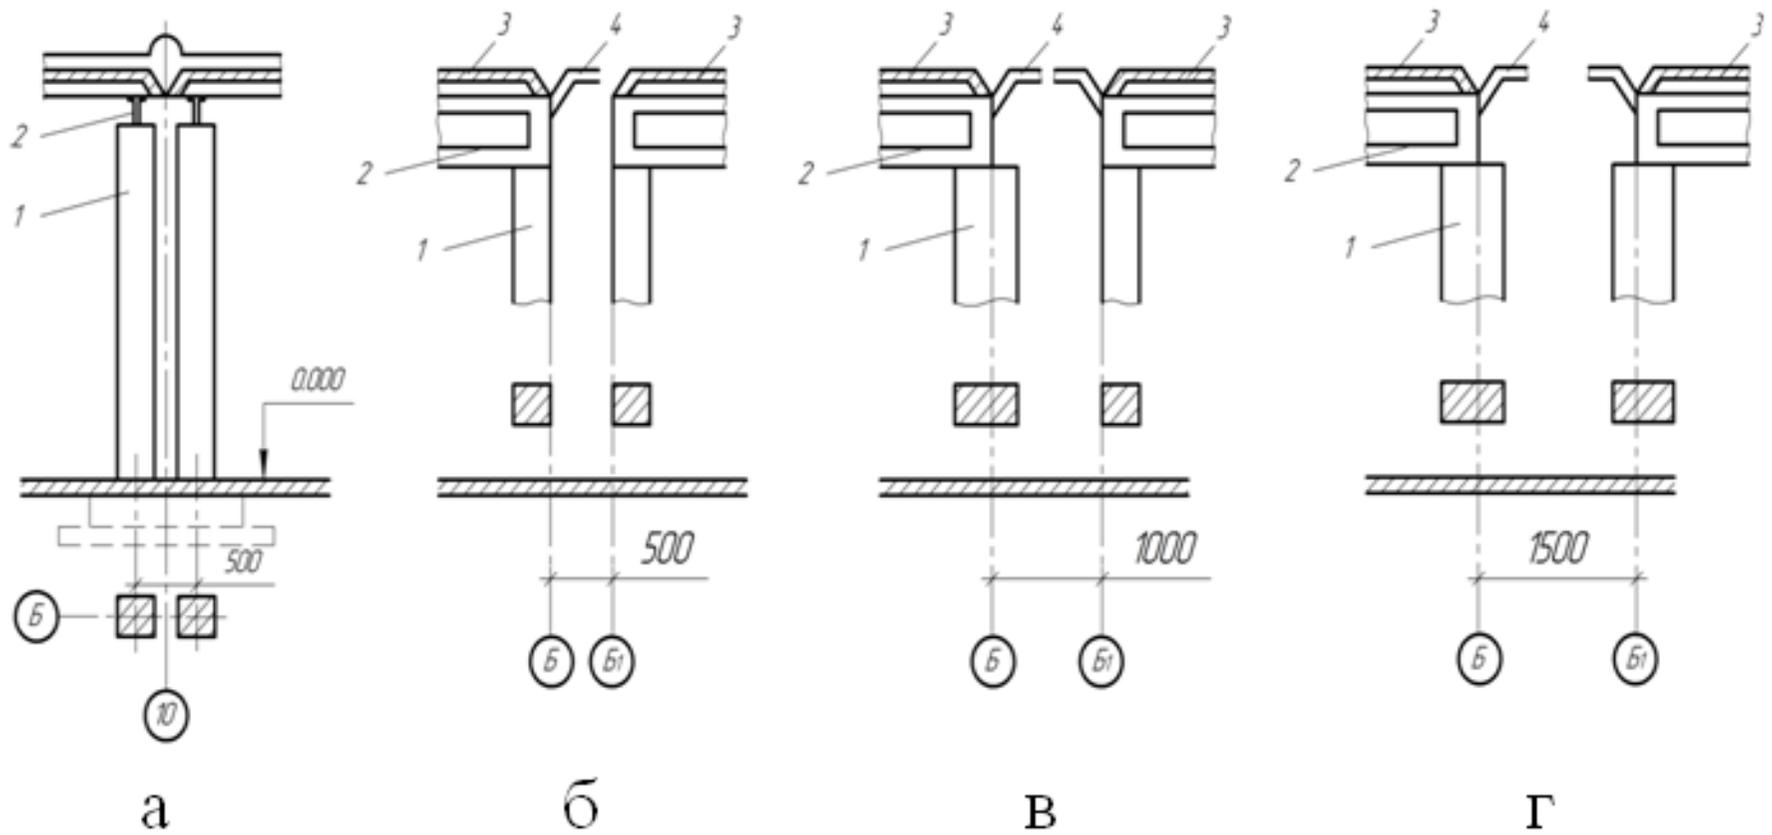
Привязка колонн к разбивочным осям в местах деформационных швов: а – в месте поперечного шва; б, в, г – в местах продольного шва в случае колонн различного сечения; 1 – колонна; 2 – стропильная балка; 3 – плита покрытия; 4 – вставка
